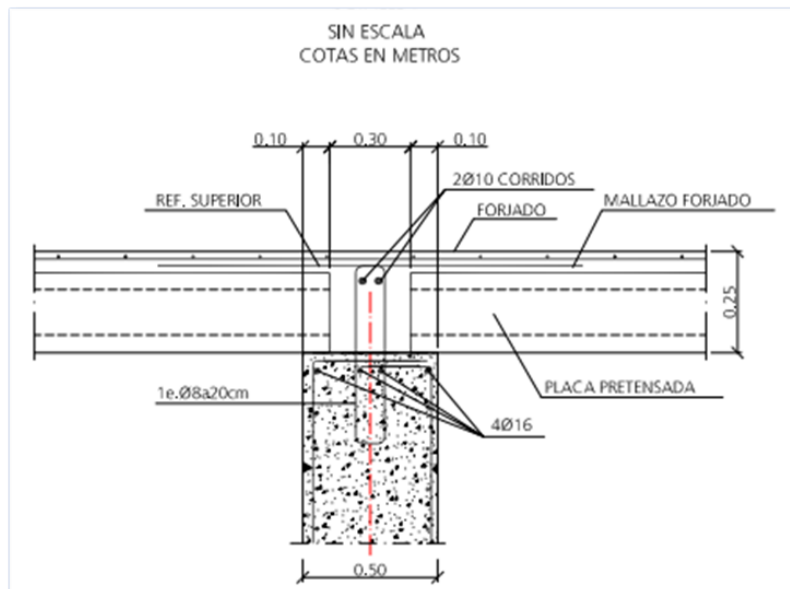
Detalle de apoyo de forjado en muro divisorio de vasos
